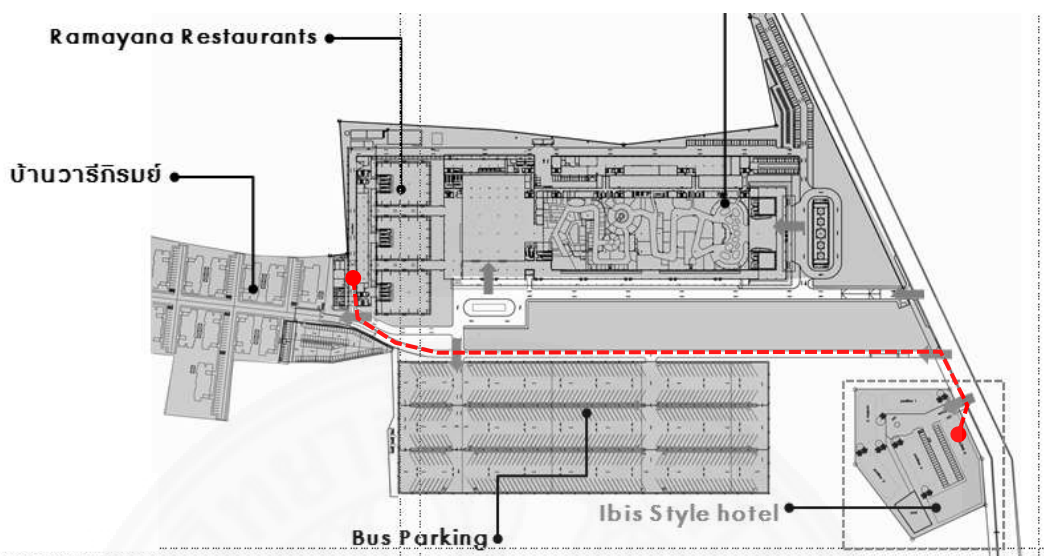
แสดงผังอาคารส่วนกลาง (Facilities Building)
